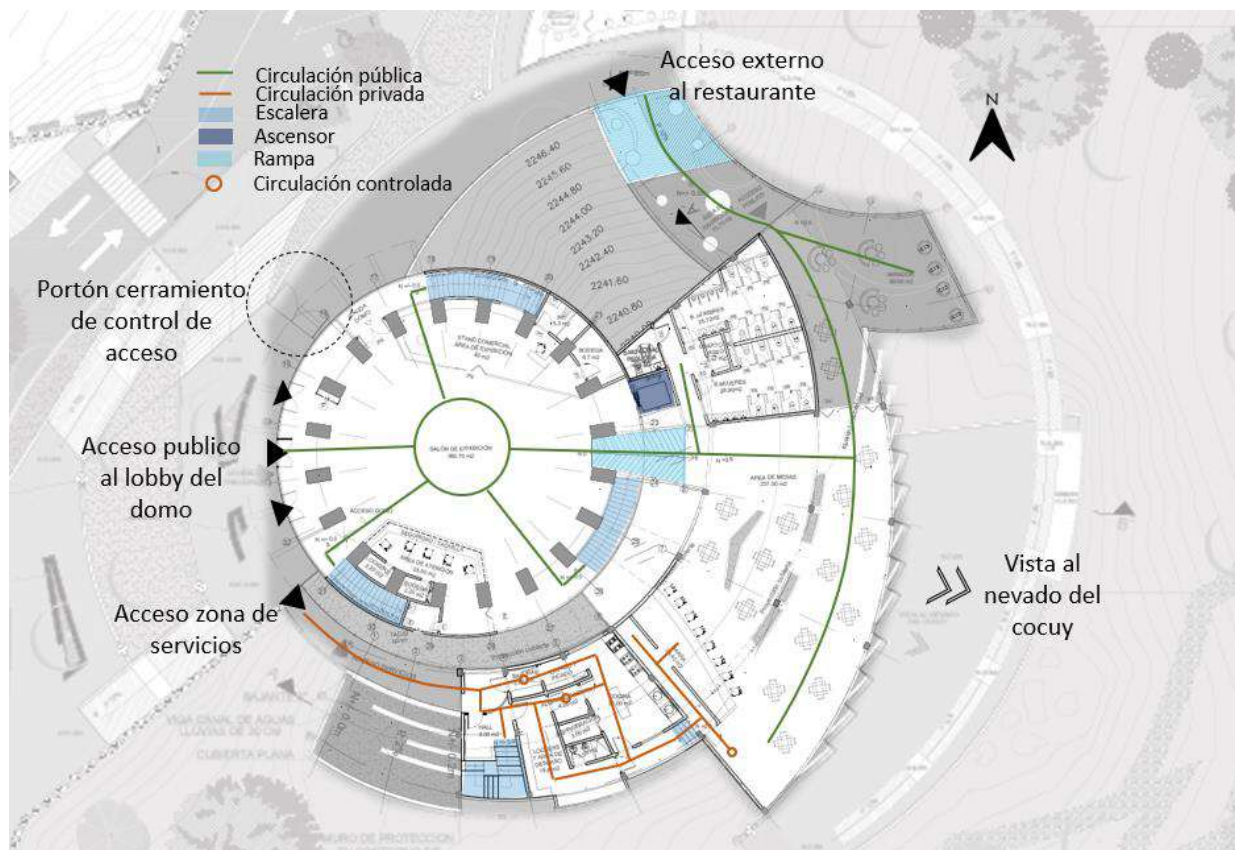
Planta general Nivel +/-0.0 edificio Norte
